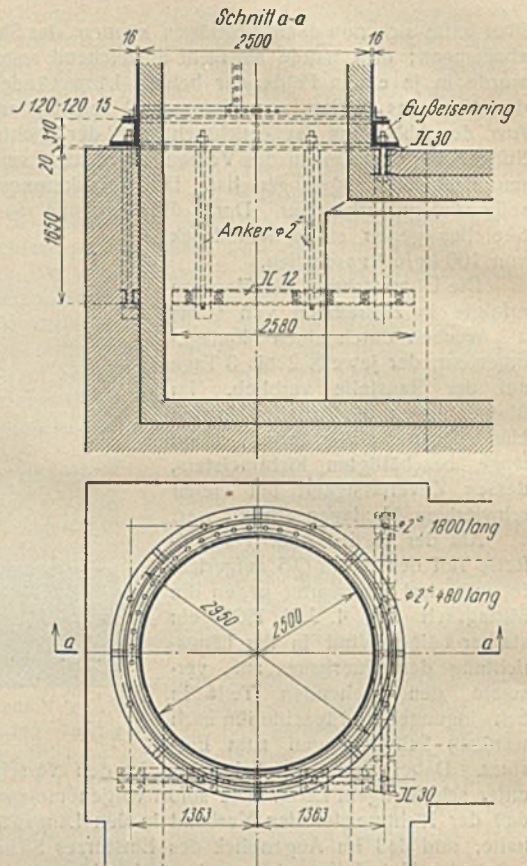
Fußausbildung und Verankerung eines Stahlblechkamines von 55 m Höhe.
